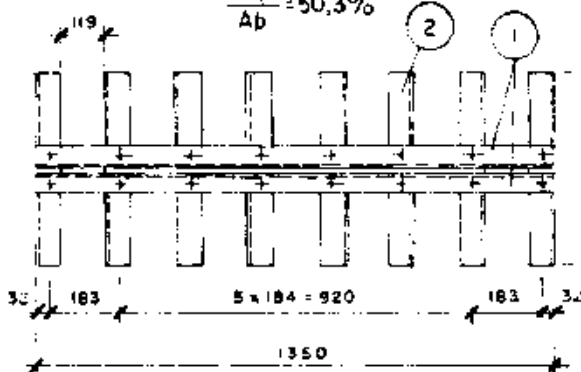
DETALHES ESTRUTURAIS DAS GRELHAS
